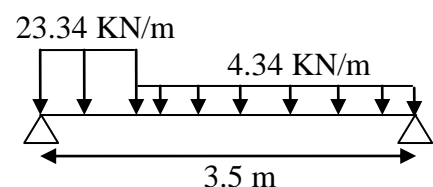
Schéma statique de la poutre de chaînage 4
